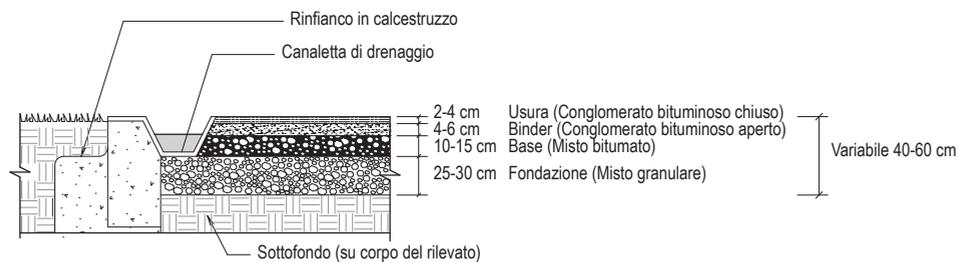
Sezione tipo di una moderna pavimentazione flessibile
